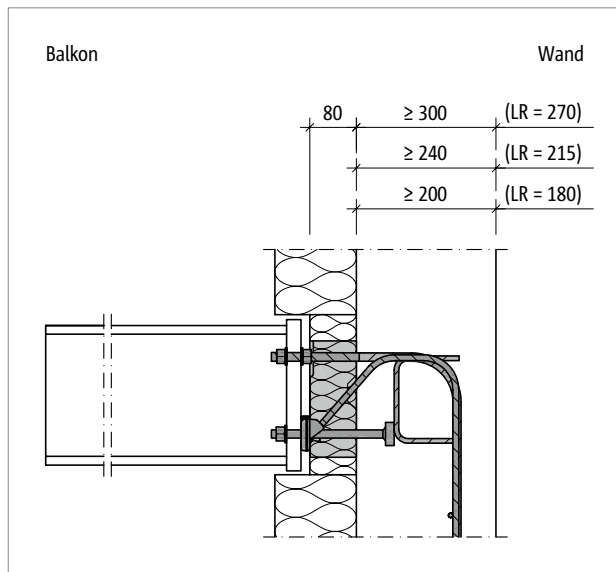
Schöck Isokorf® T type SK: aansluiting op gevelisolatie met behulp van een nok aan de vloer, rekening houdend met de randafstanden ten aanzien van de minimaal vereiste betondekking
